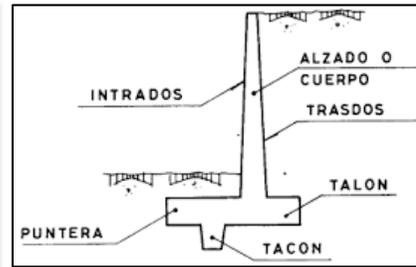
detalle constructivo de defensa ribereña – muro de contención armado.
